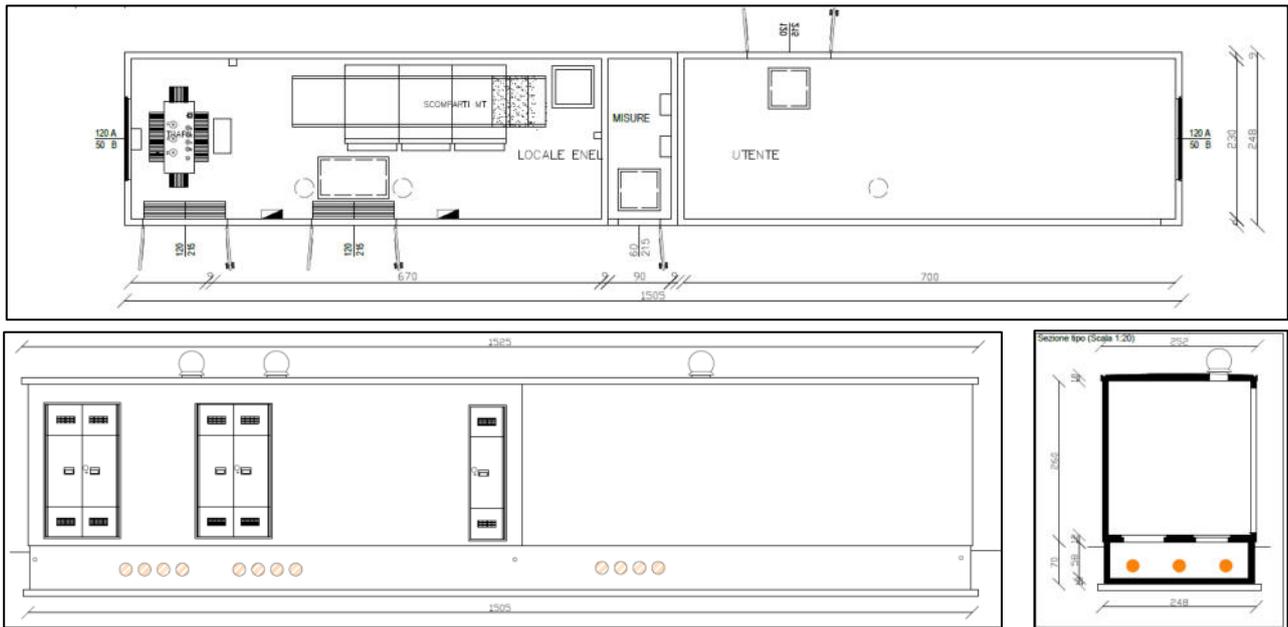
Vista in pianta/prospetto/sezione della cabina di consegna.
